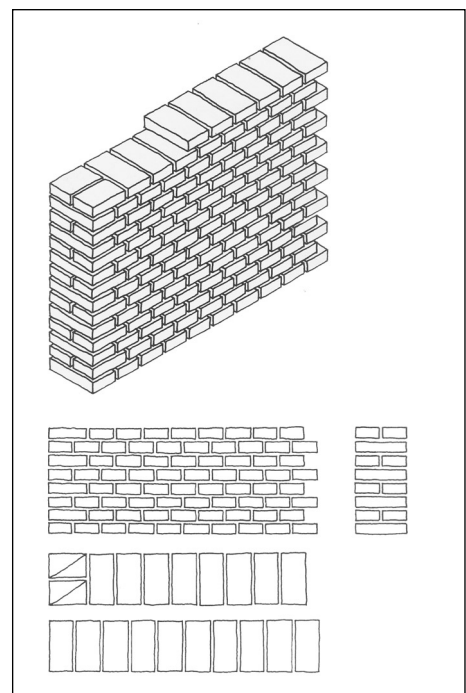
Muro a due teste concatenato di testa. Veduta assonometrica, prospetto, sezione e pianta dei corsi di mattoni (Immagine tratta da A. Acocella, *L'Architettura del Mattone faccia a vista*, Roma 1989.)
